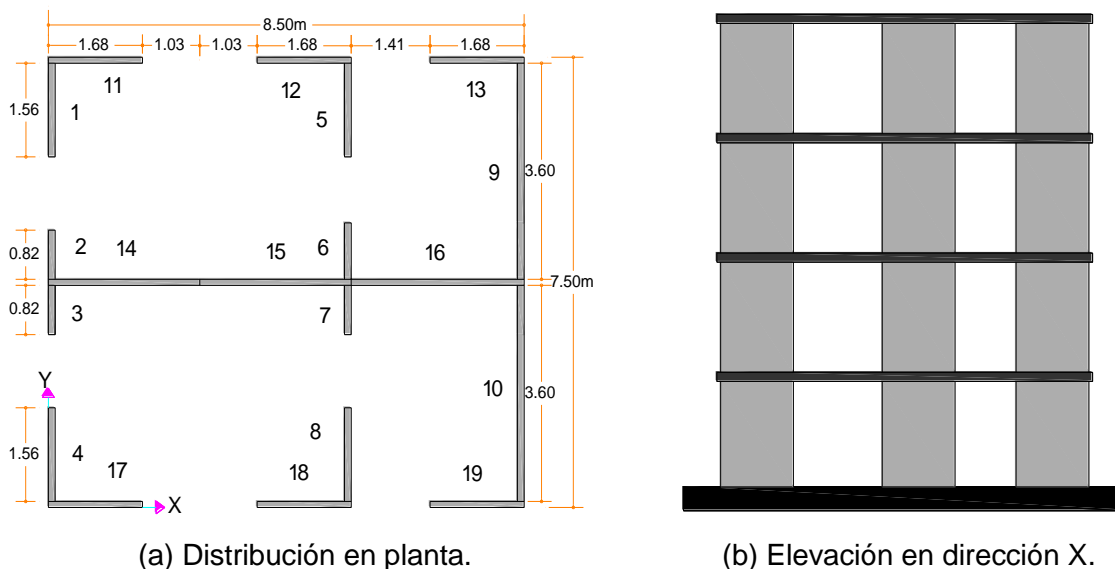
Planta y elevación de estructura de concreto reforzado.
